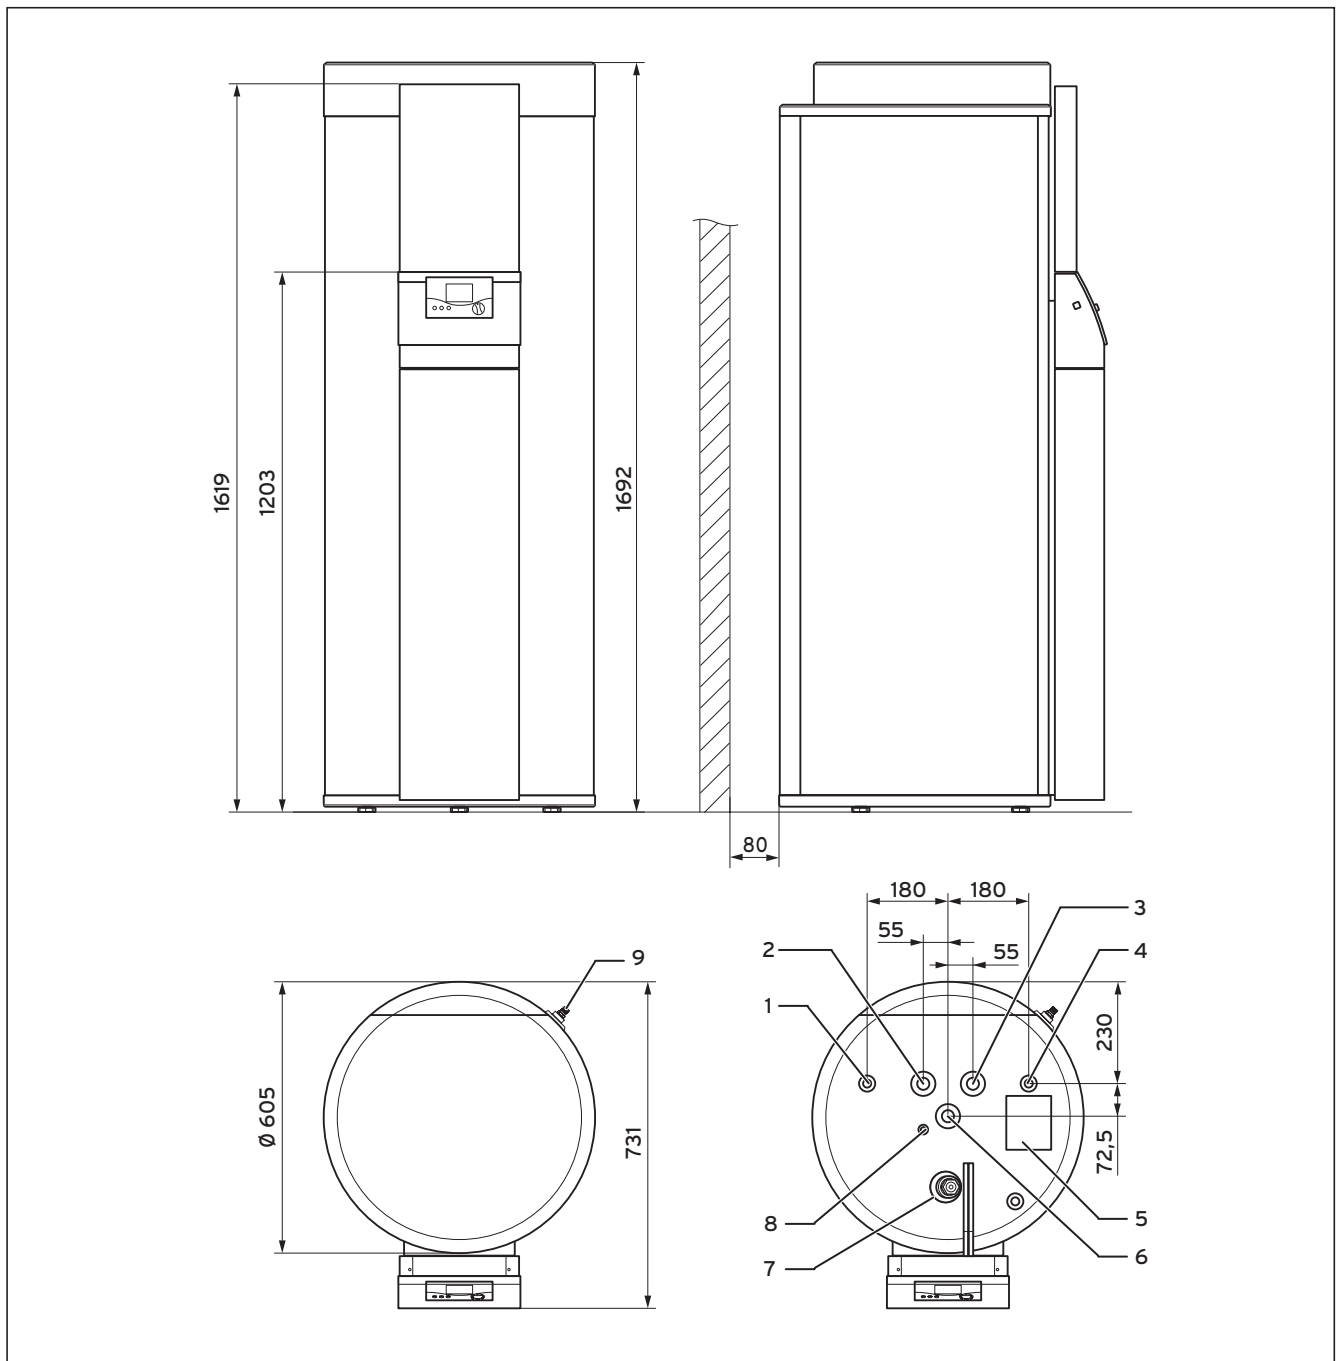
Размеры аппарата и патрубка блока солнечного водонагревателя
